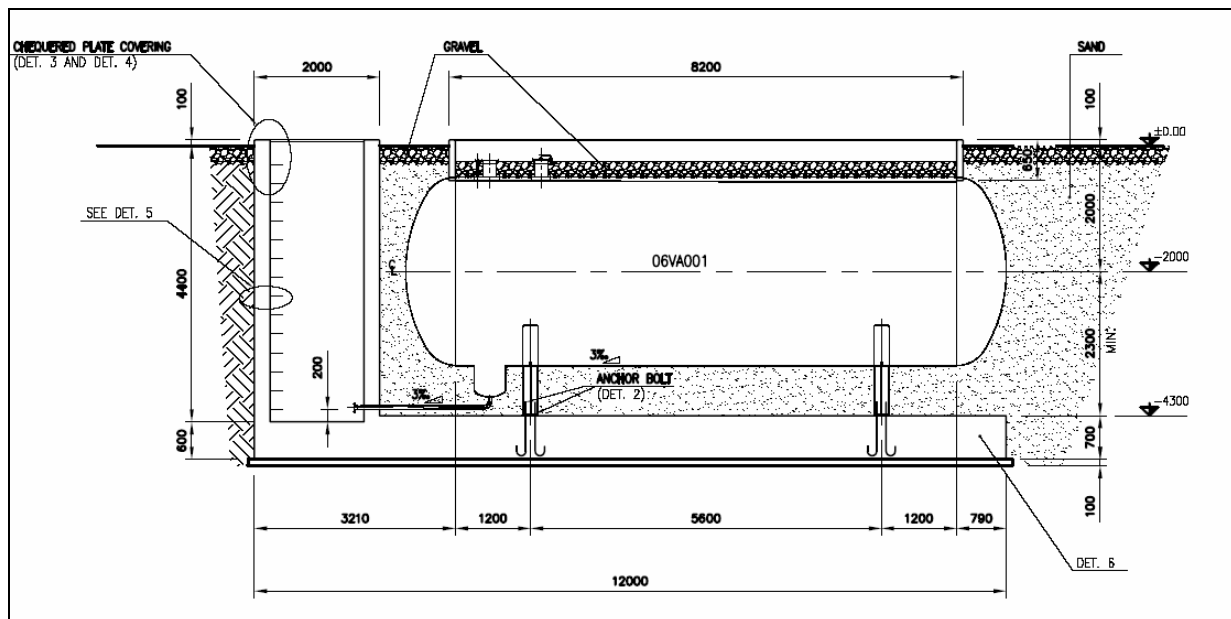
Serbatoi interranti - sezione longitudinale
